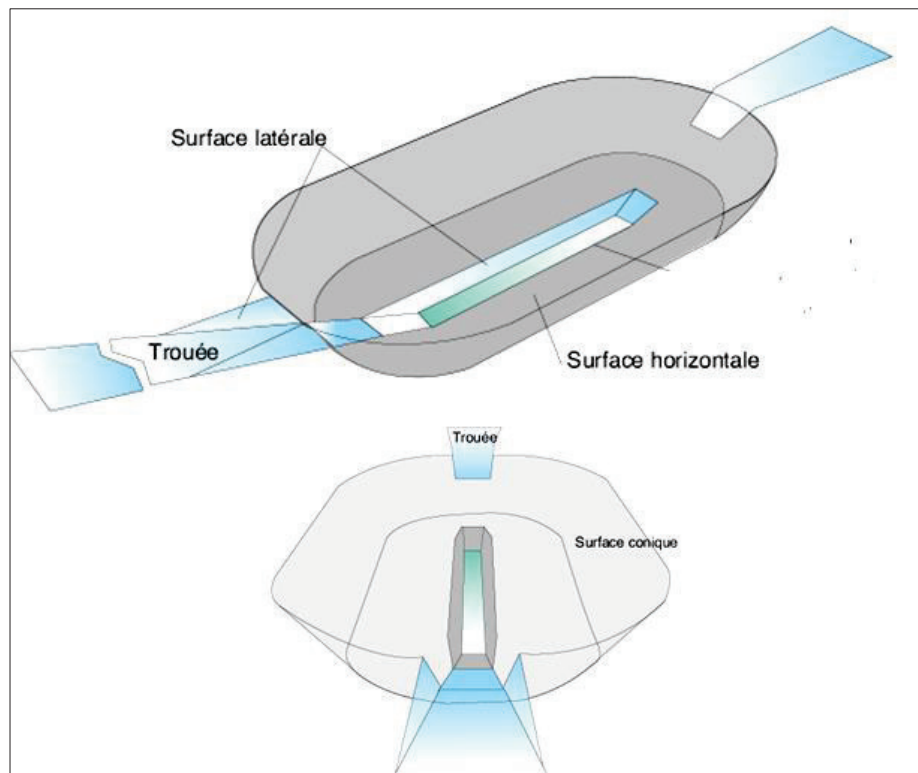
VUE EN PERSPECTIVE DES SURFACES DE DEGAGEMENT
